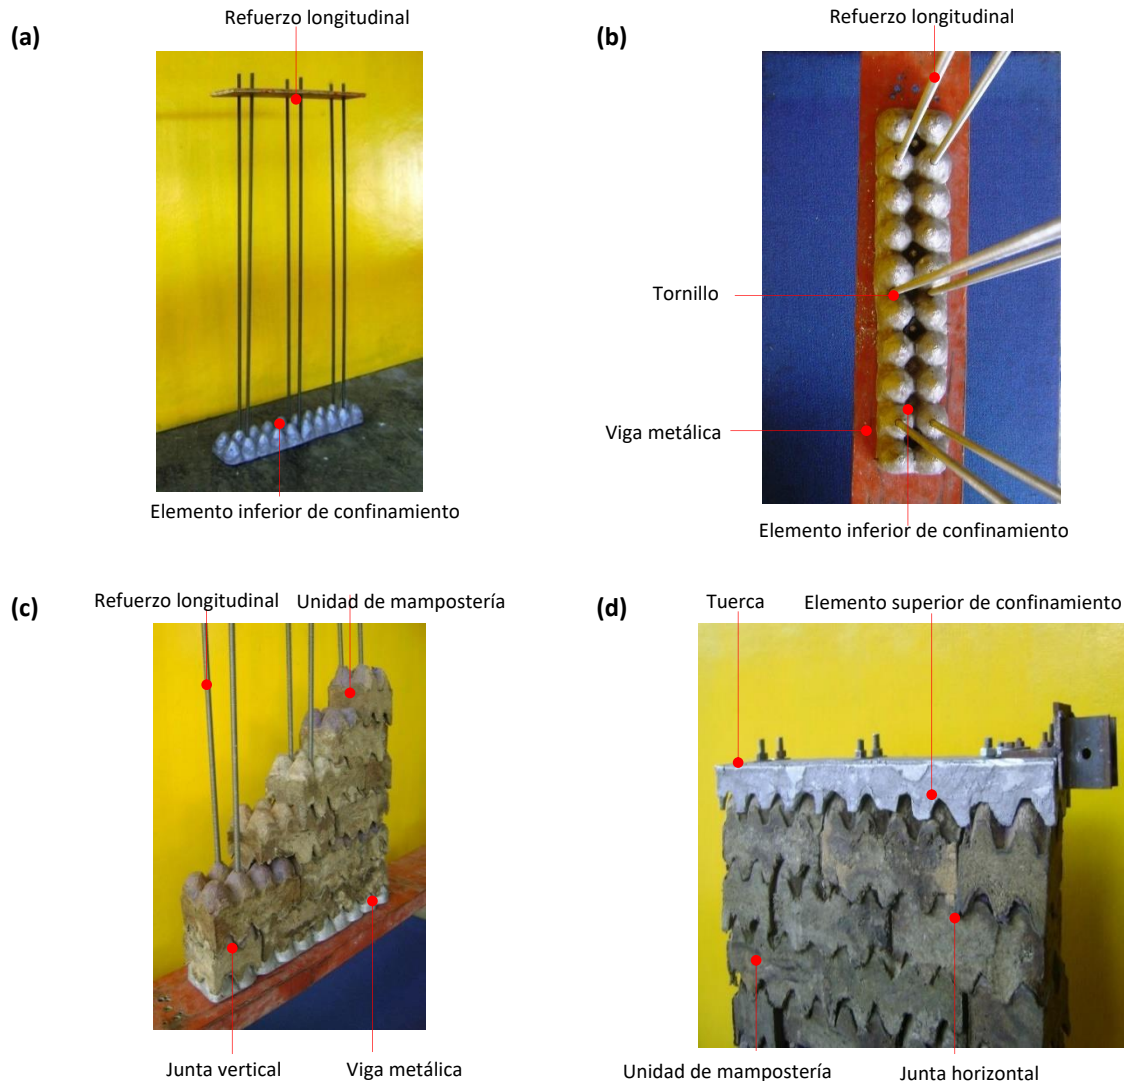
Etapas del proceso de ensamblaje del panel. (a) Elemento inferior de confinamiento. (b) Instalación de refuerzo longitudinal. (c) Instalación de unidades de mampostería y (d) Instalación elemento superior de confinamiento.
